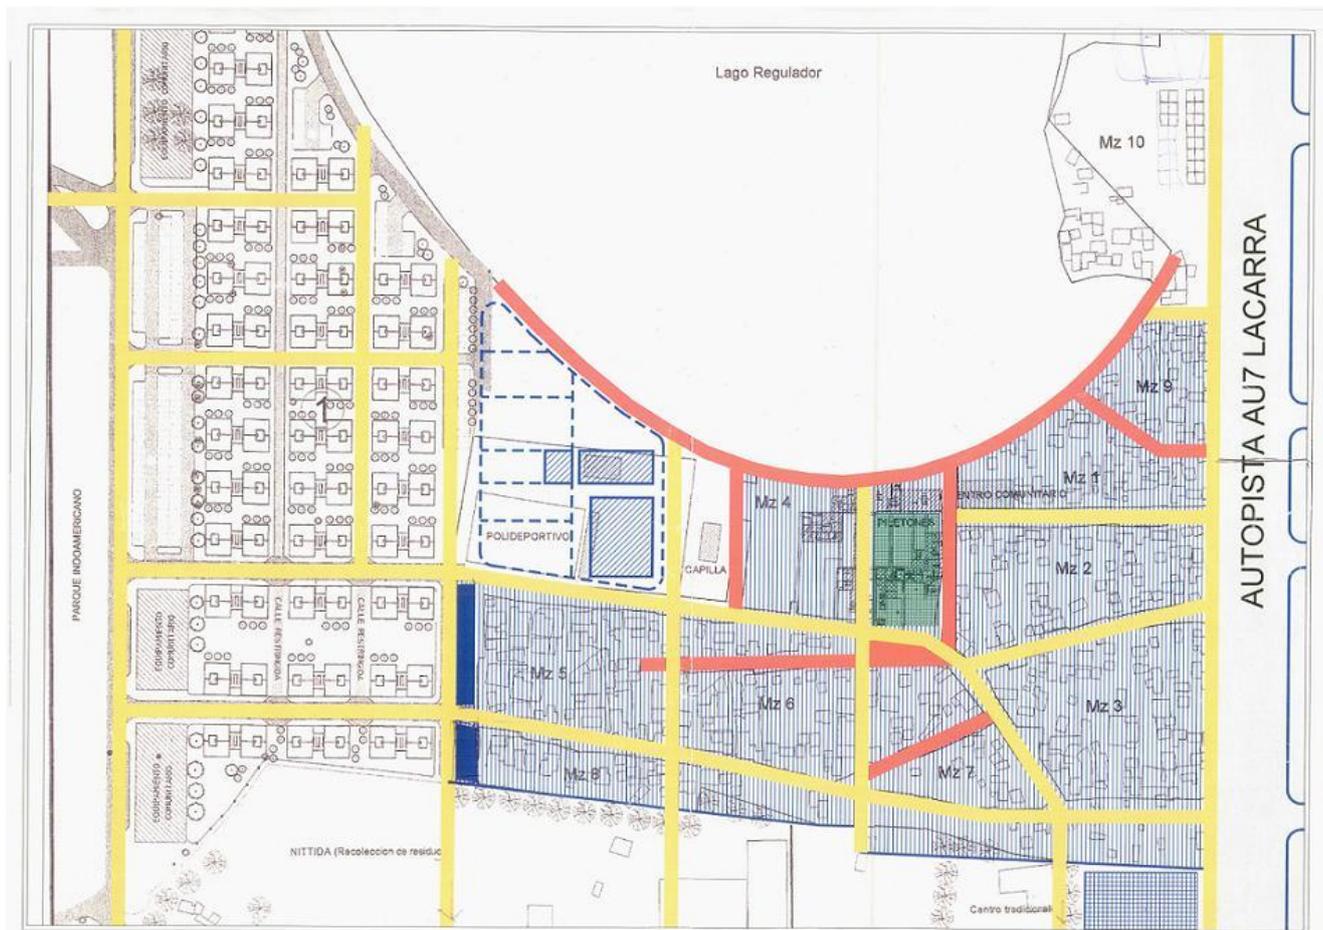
Sector del Barrio Los Piletones afectado a obras de infraestructura (en rayado vertical azul).
